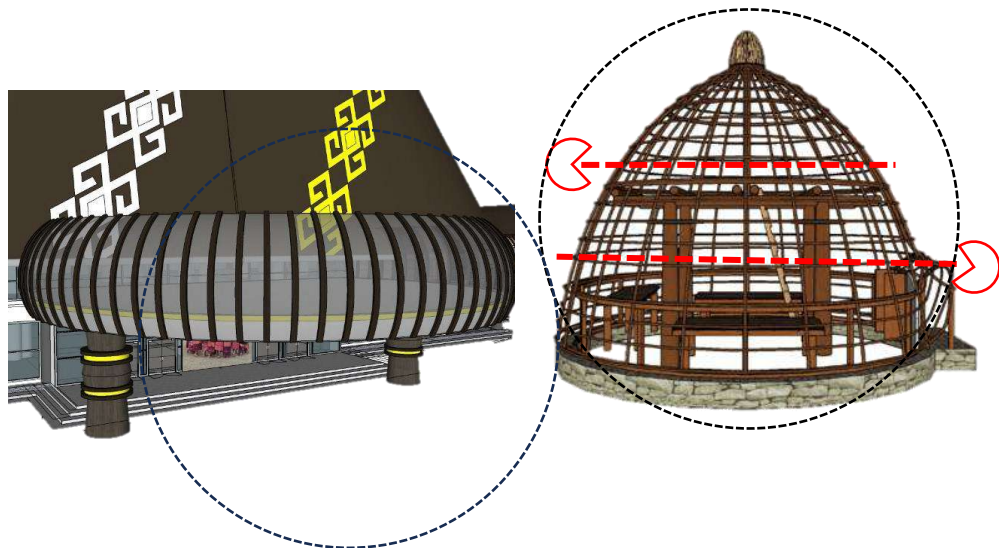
Konsep Fasad Masa Bangunan Theater dan Ruang Kelas
